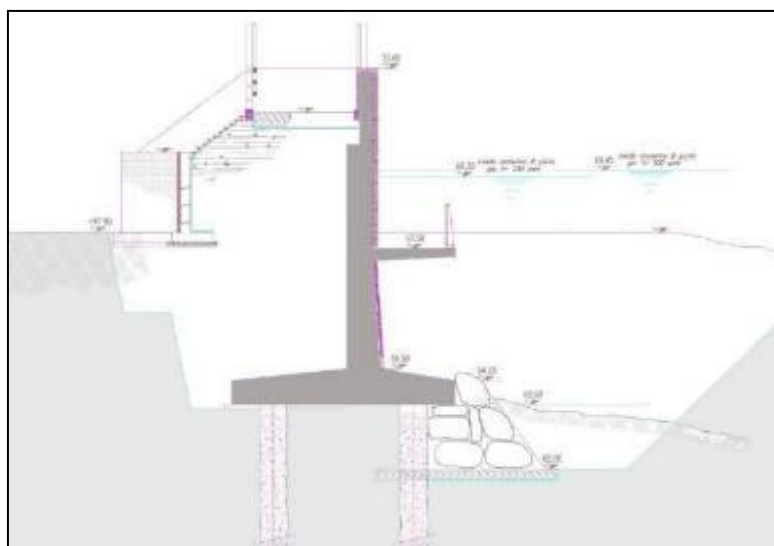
Sezione tipo del muro arginale in zona ex SICC
